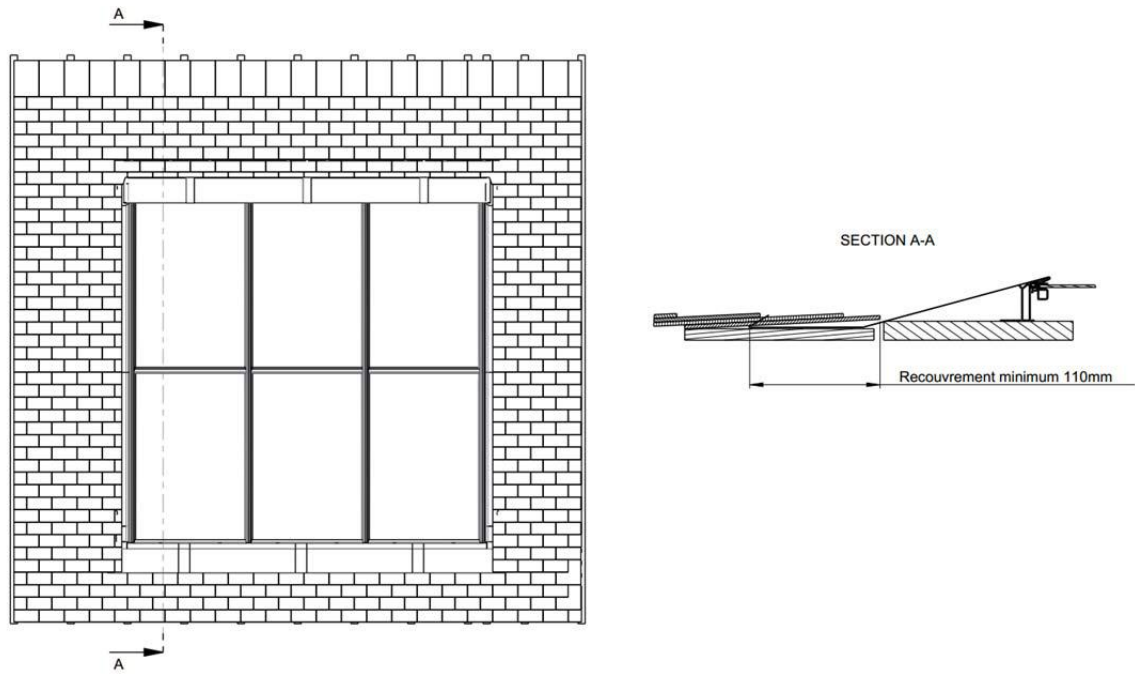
Recouvrement des abergements supérieurs pour installation sur toiture ardoise
